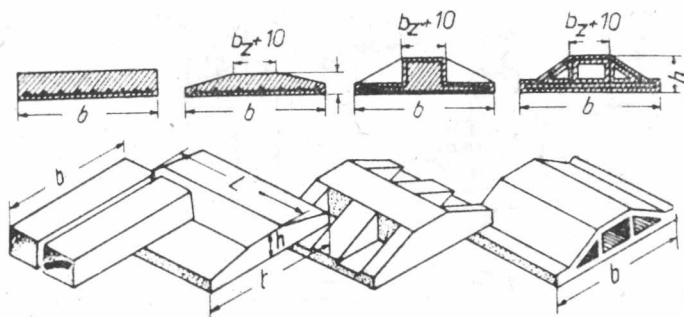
Blocuri prefabricate din beton armat pentru fundații continue.
